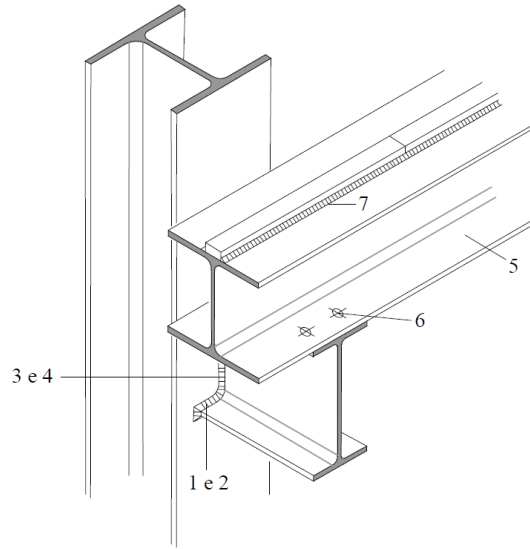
Pormenor tipo de ligação no nó de uma viga de caminho de rolamento.
